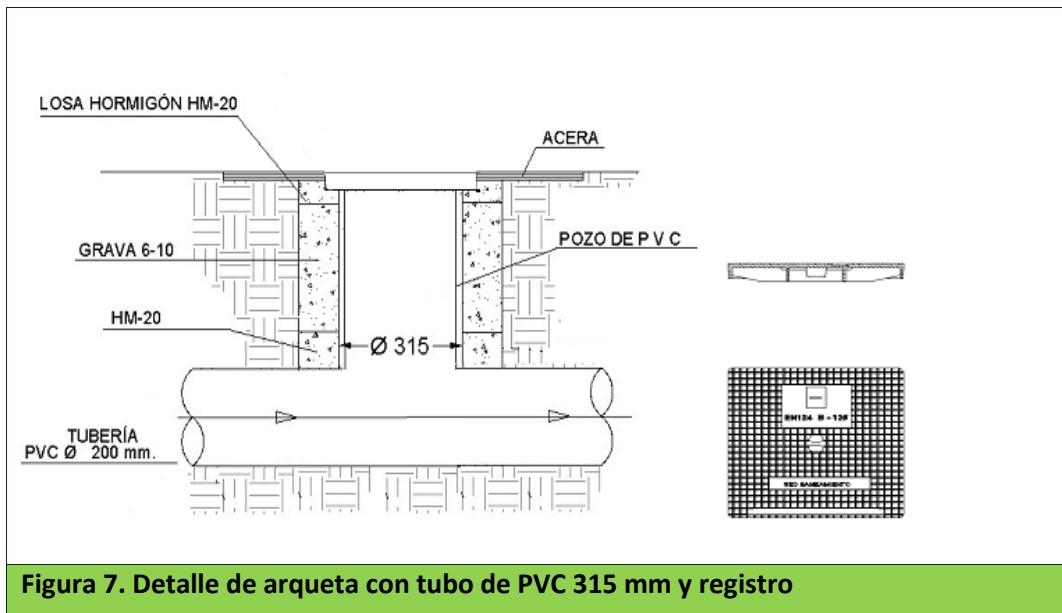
Detalle de arqueta con tubo de PVC 315 mm y registro
